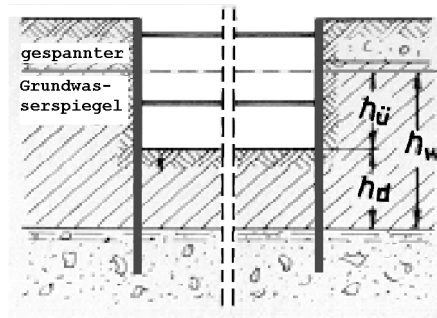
Spundwandumschließung mit aussteifenden Geschossdecken [3.17]
